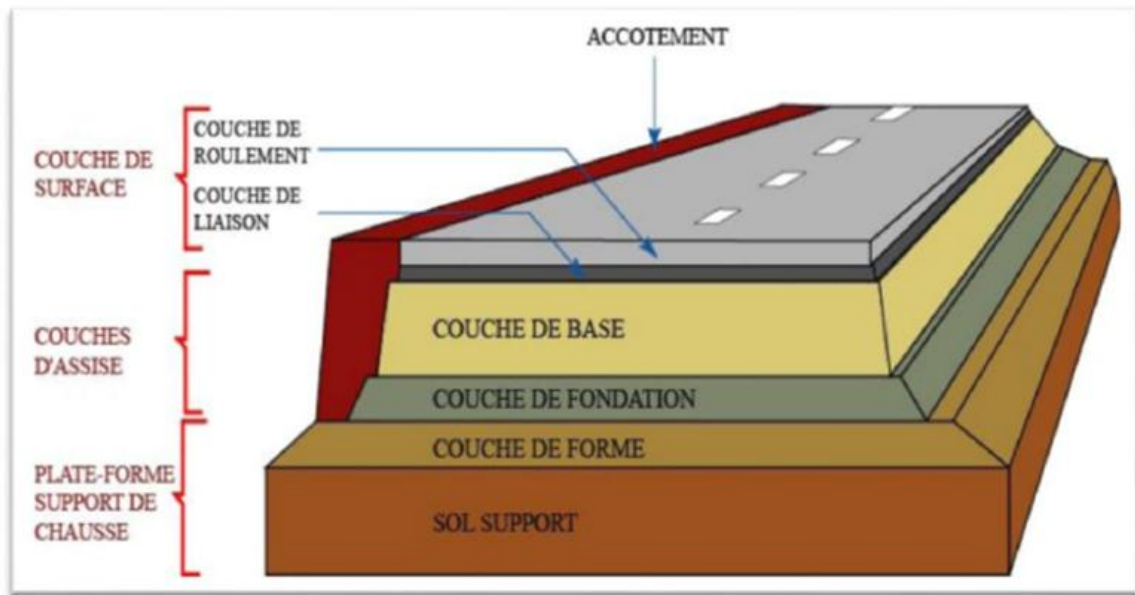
Différentes couches d'une structure de chaussée [6]
